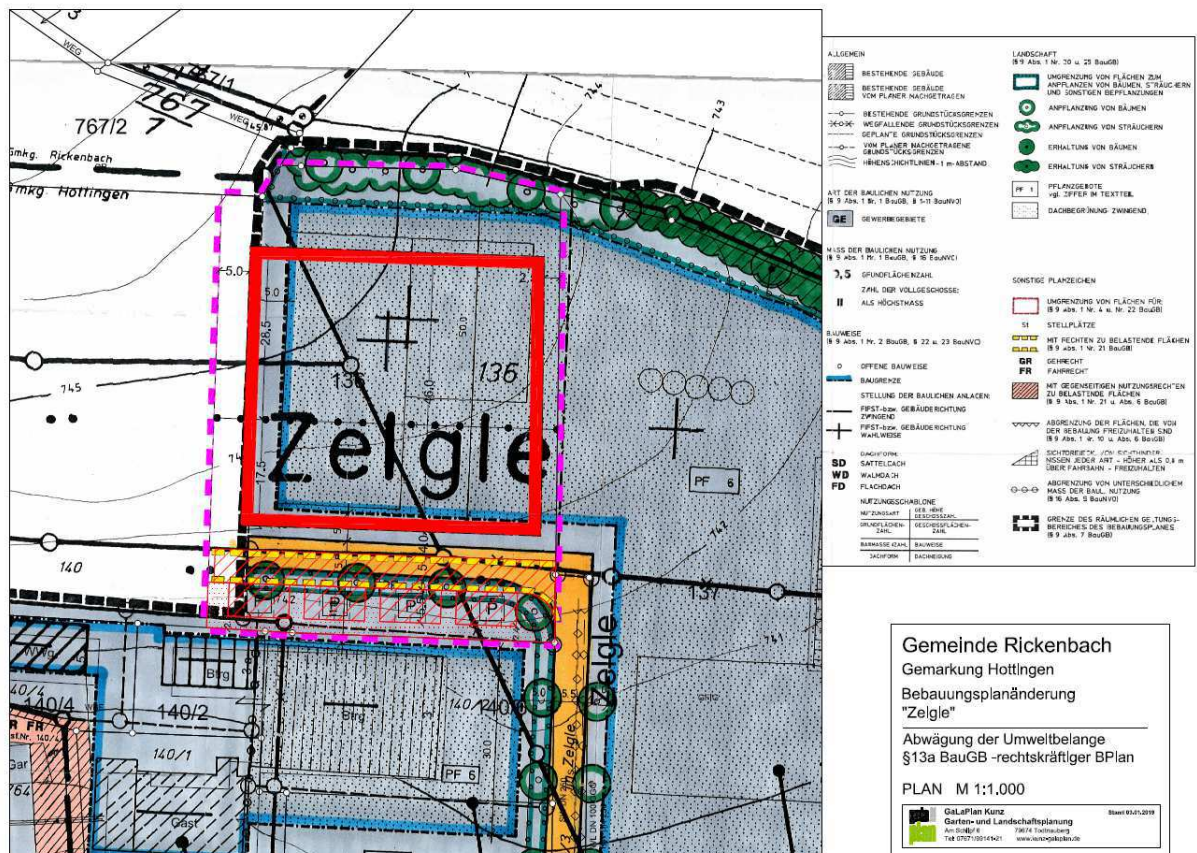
1. Bebauungsplanänderung Zelgle; neue Planung (rot = Baufenster, pink = Plangebiet) auf Grundlage des alten Bebauungsplans
